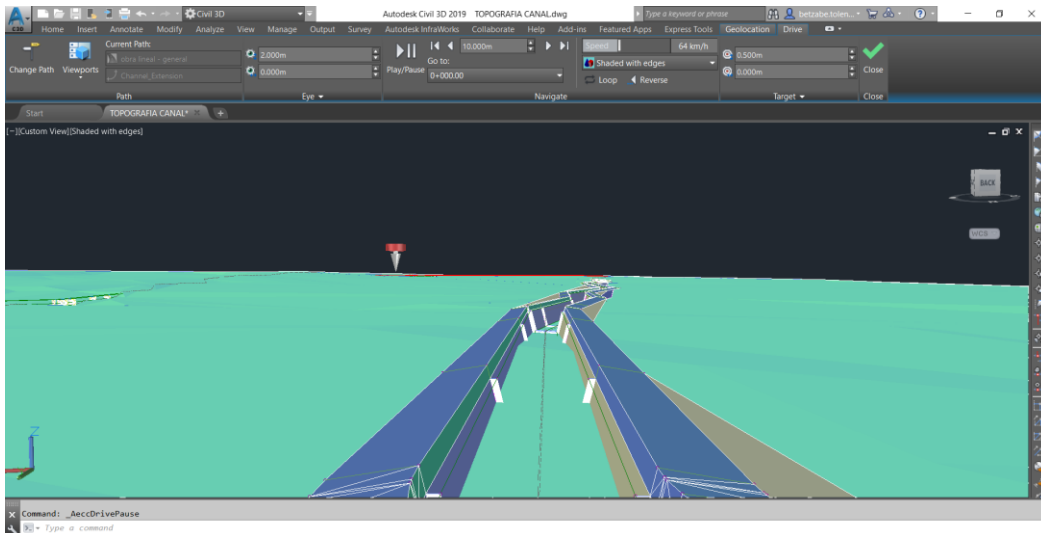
Vista elevada, modelado trapezoidal – Km 1+262.25m
